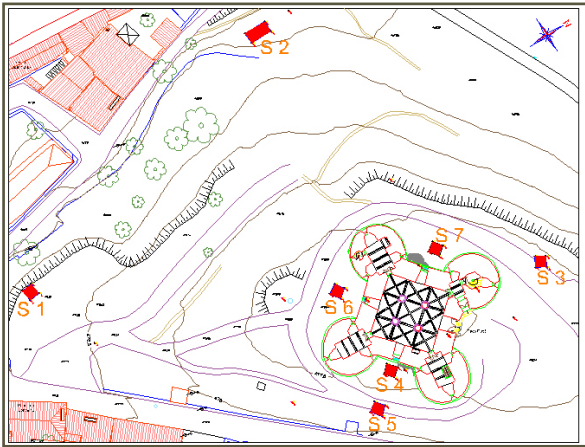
Planta geral da área intervencionada com implantação das sondagens
